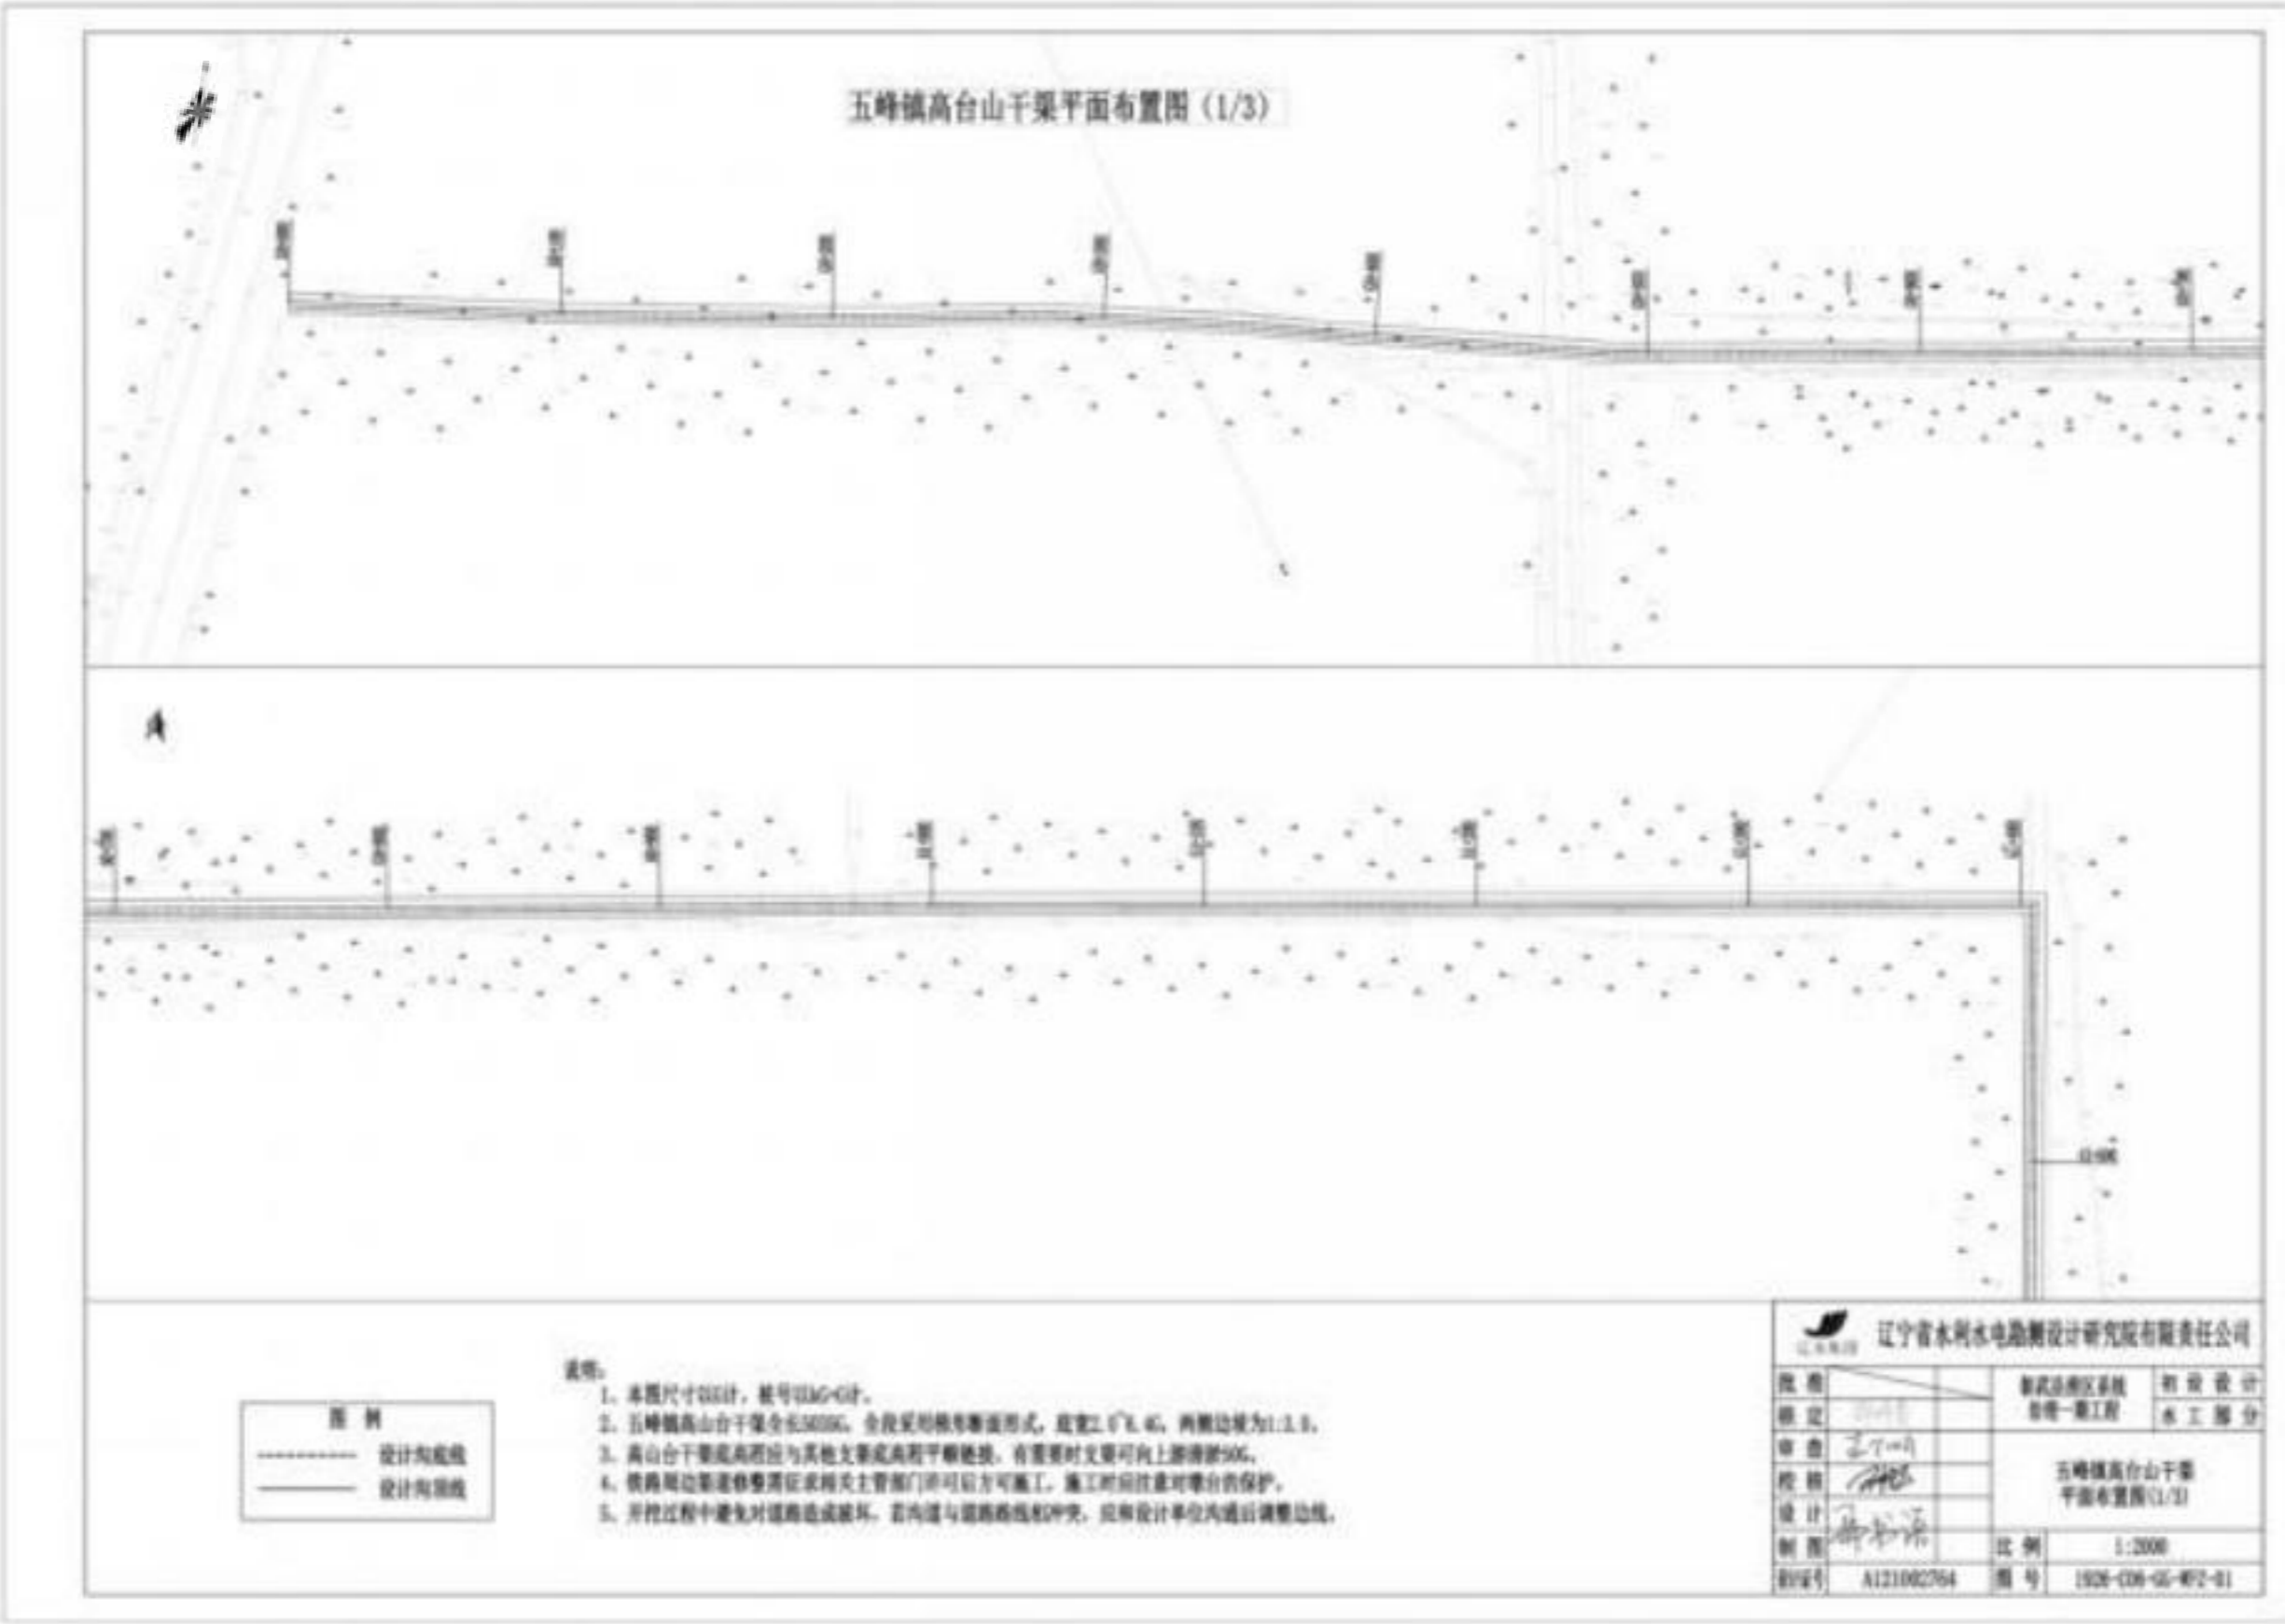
(1) 五峰镇高山台干渠平面布置图
